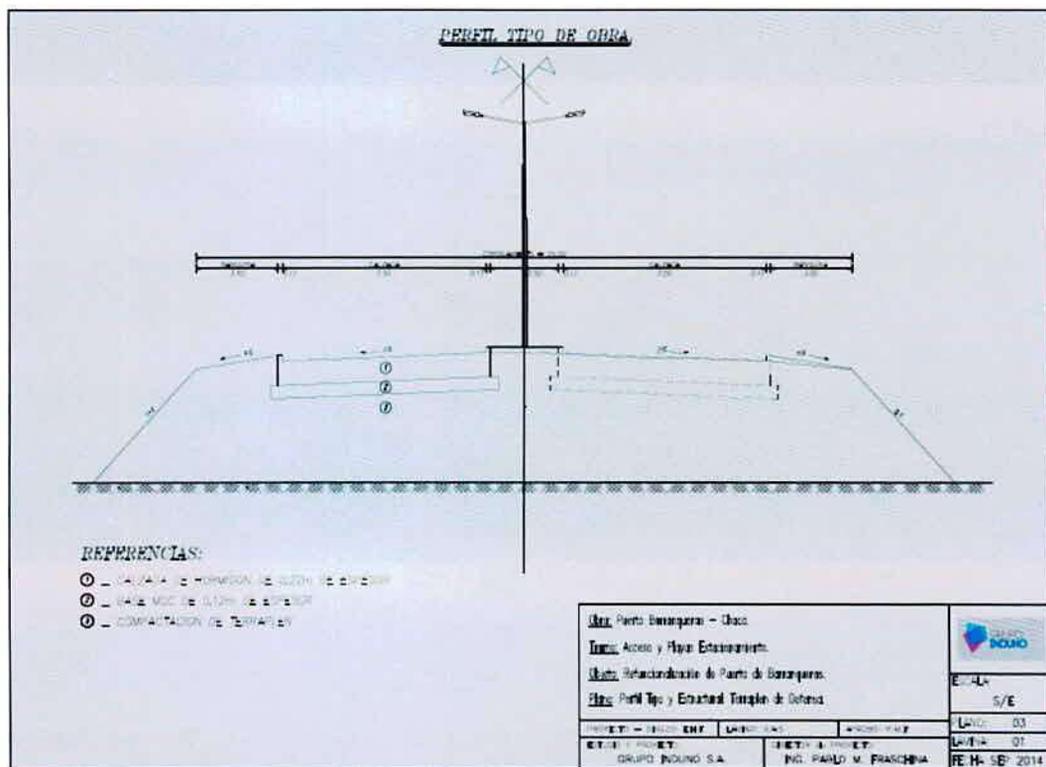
Perfil tipo de obra: Obra nueva sobre terraplén de defensa secc. 4 - fuente: Proyecto Ing
